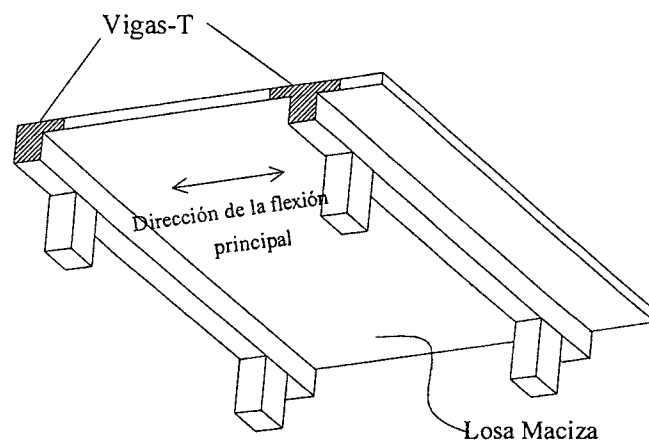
Vigas T en una losa maciza armada en una dirección.
